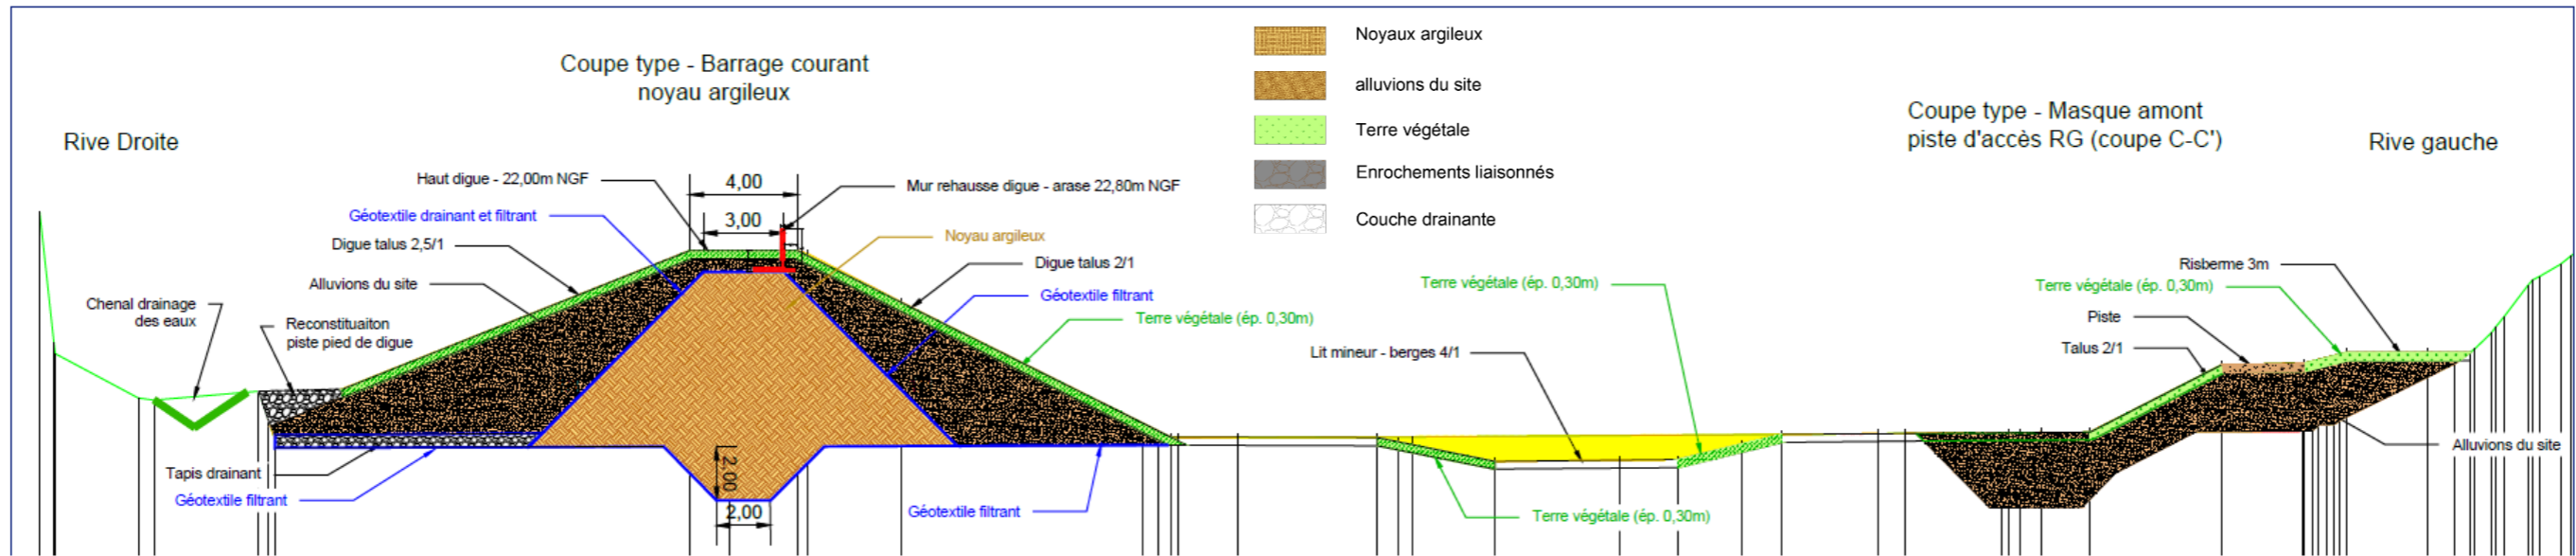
Coupe C-C' de la section courante – Plan AVP
